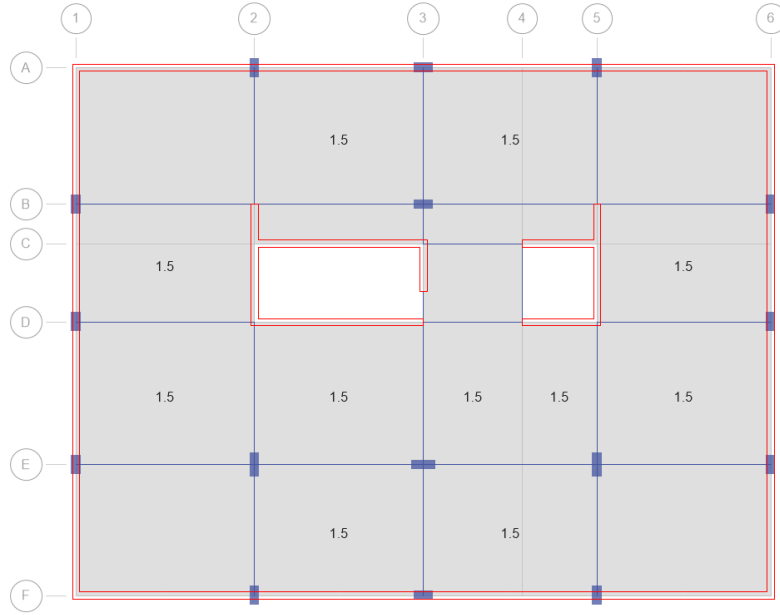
5.Kat Plan Görünümü (Örnek-4)
